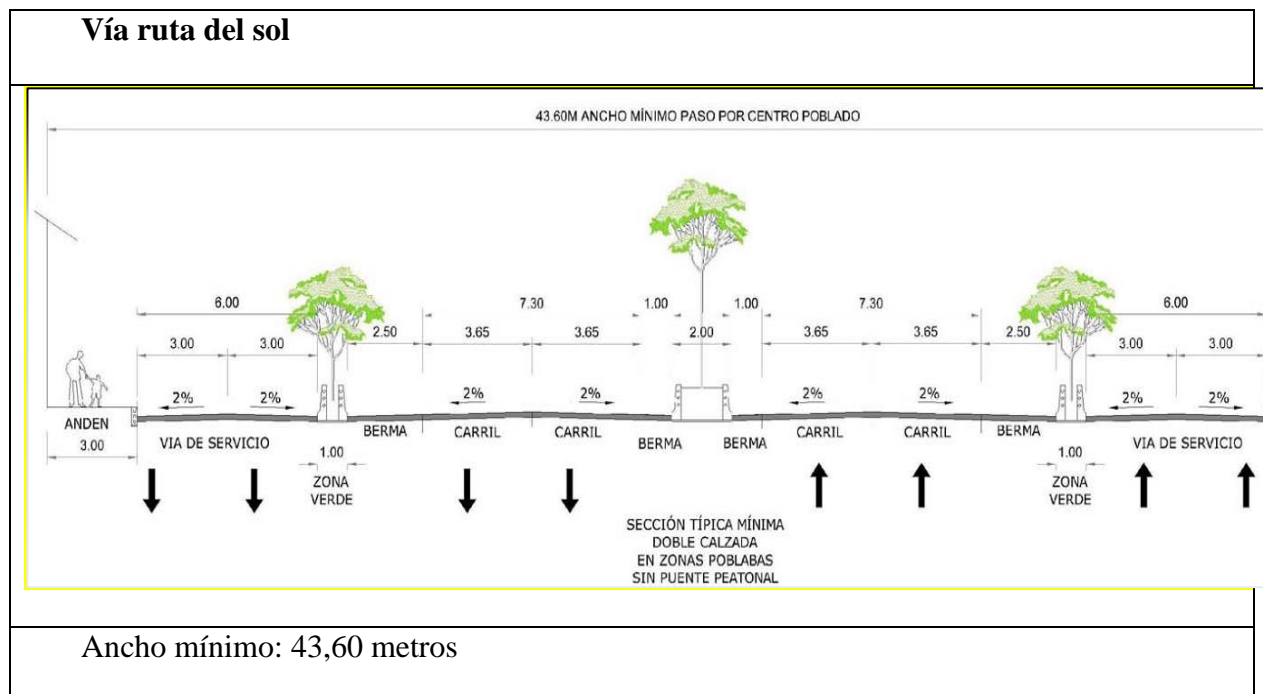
Perfil vial Ruta del Sol. Fuente. Acuerdo 018 de 2002, Barrancabermeja.
